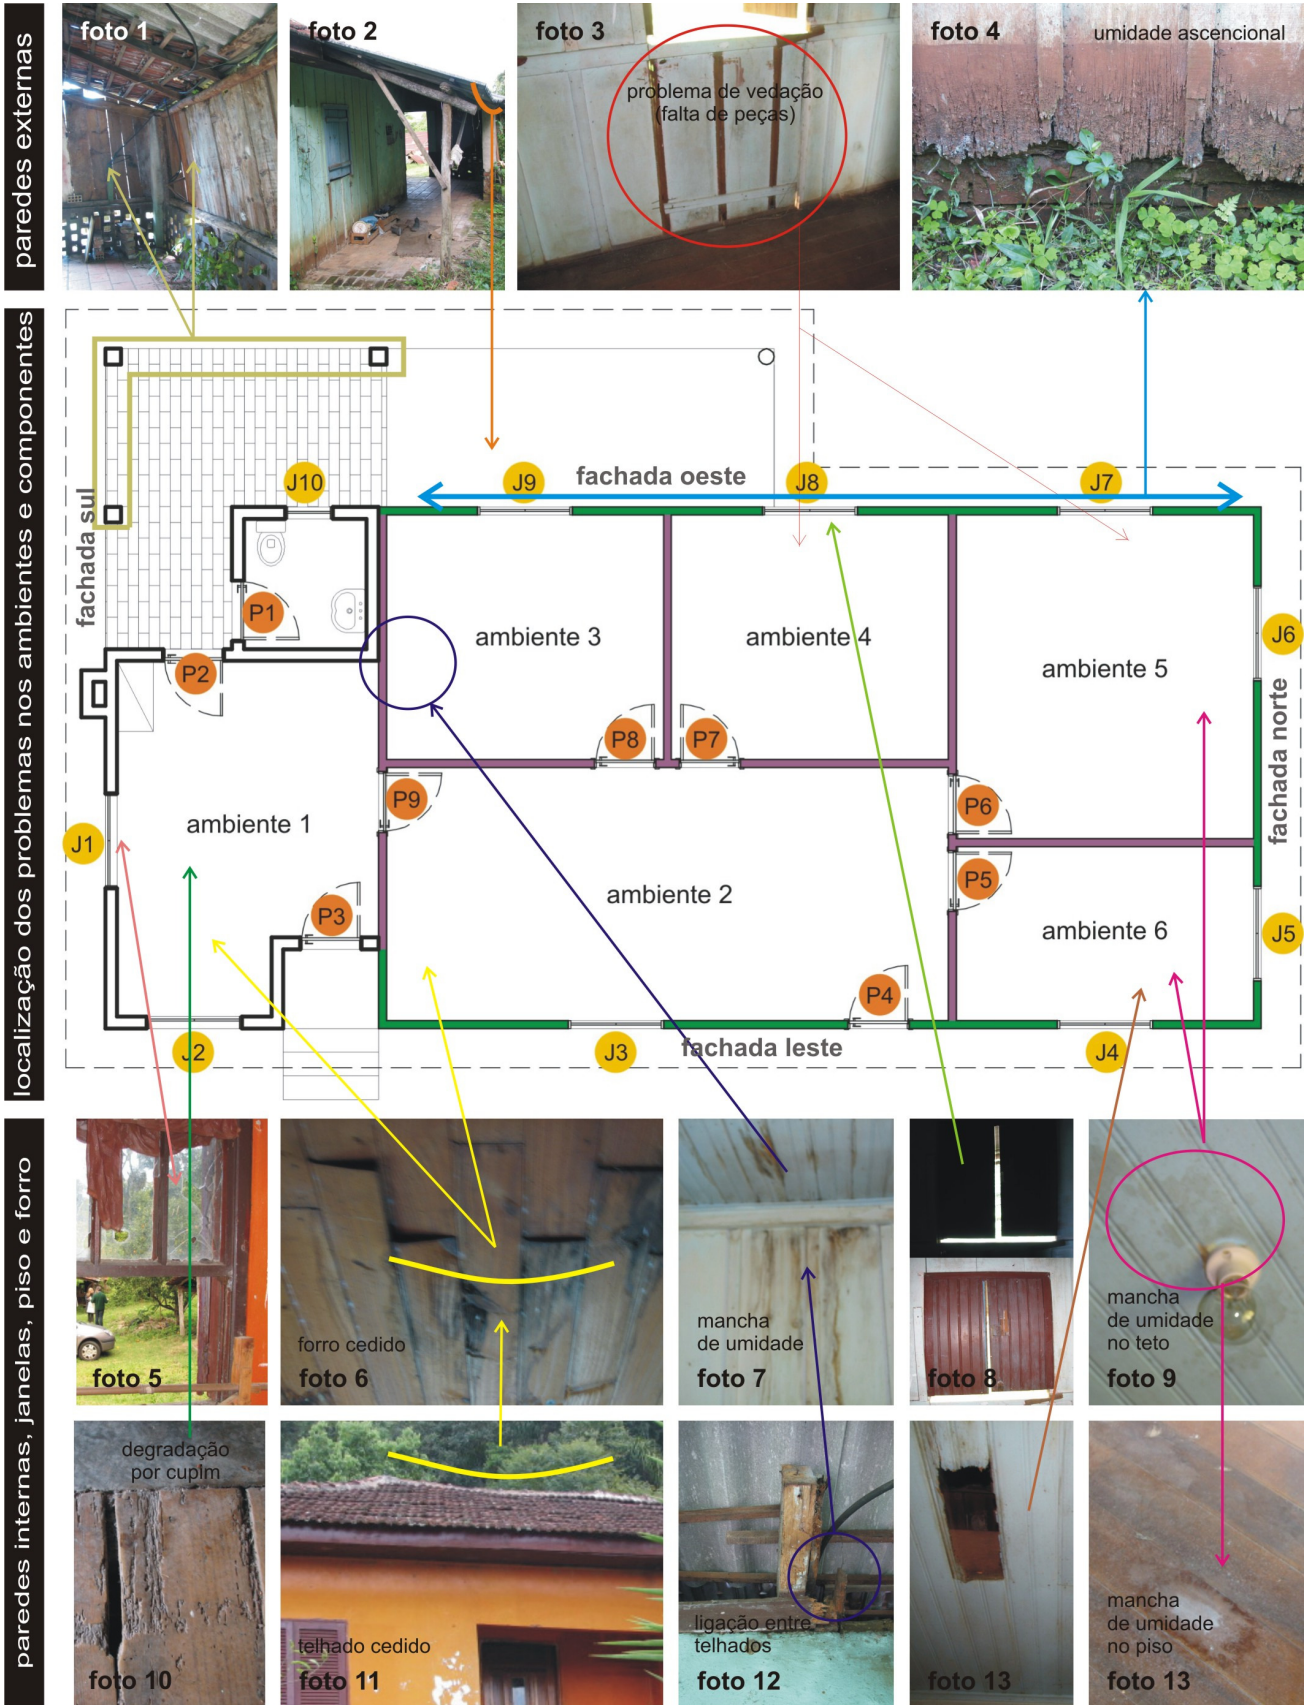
Planta baixa esquemática e fotos das anomalias encontradas no levantamento
